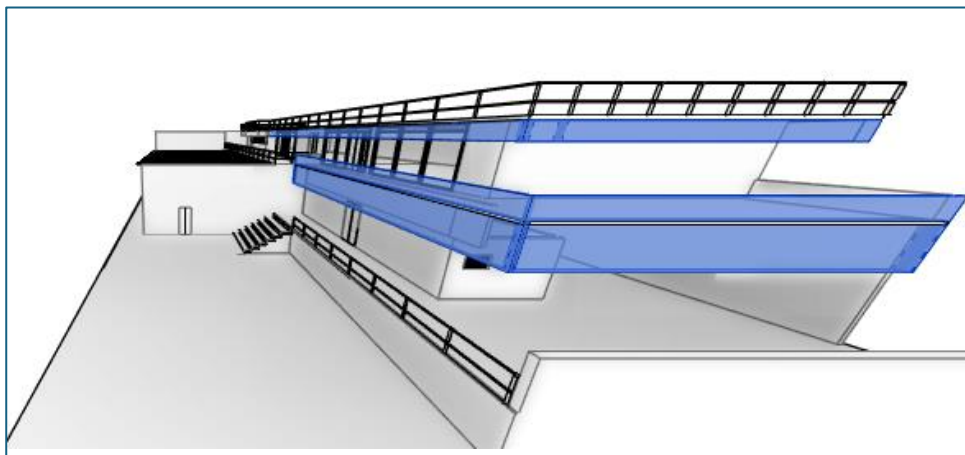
Vista Lateral dos pontos de intervenção na fachada
